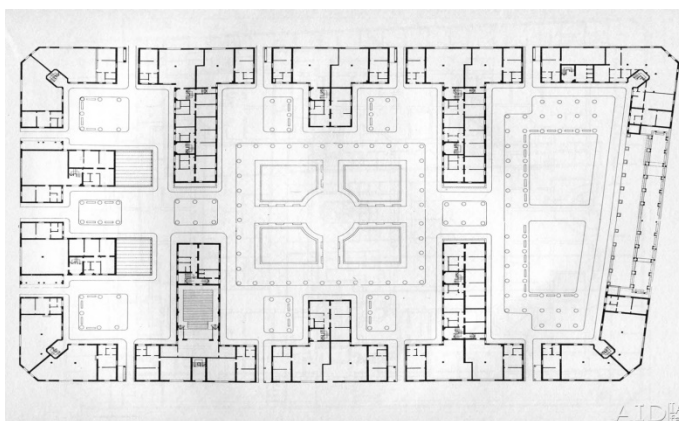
Planta baja del Conjunto Los Andes. Arq. Fermín Bereterbide.
